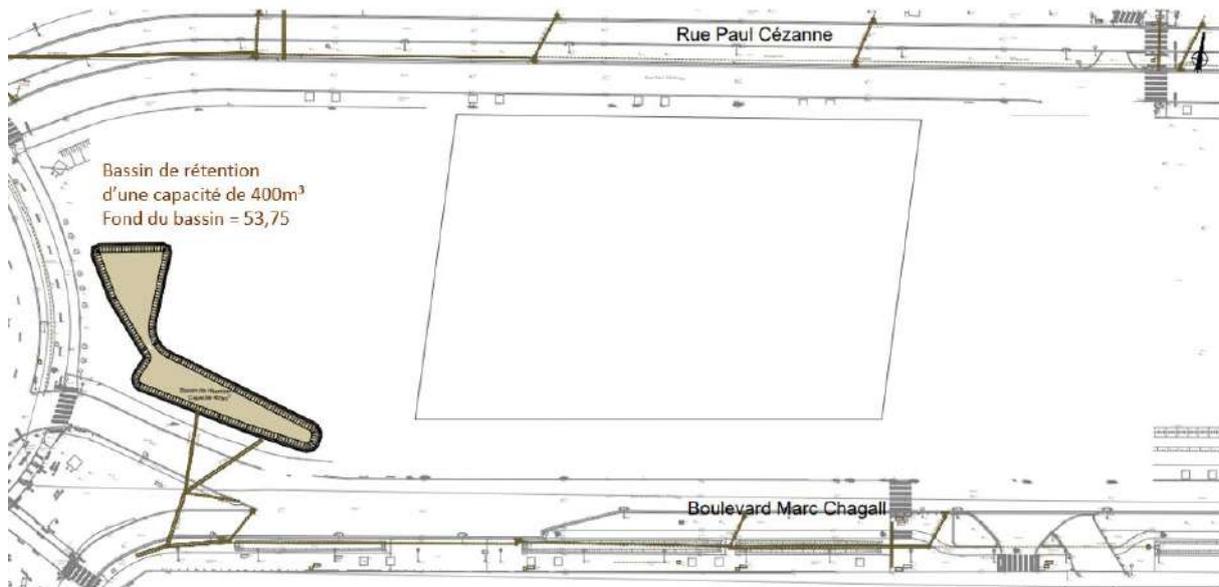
Plan des réseaux existants aux abords du site avant la Phase 1
